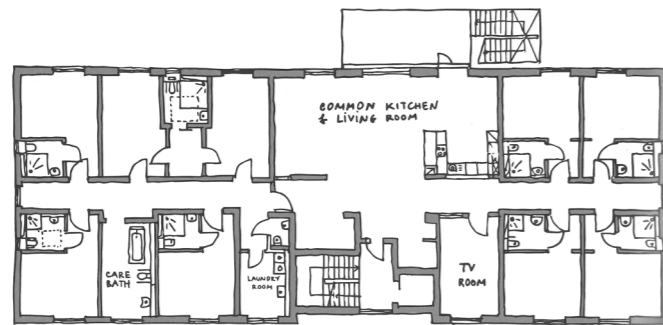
Inklusiv wohnen Köln Grundriss
